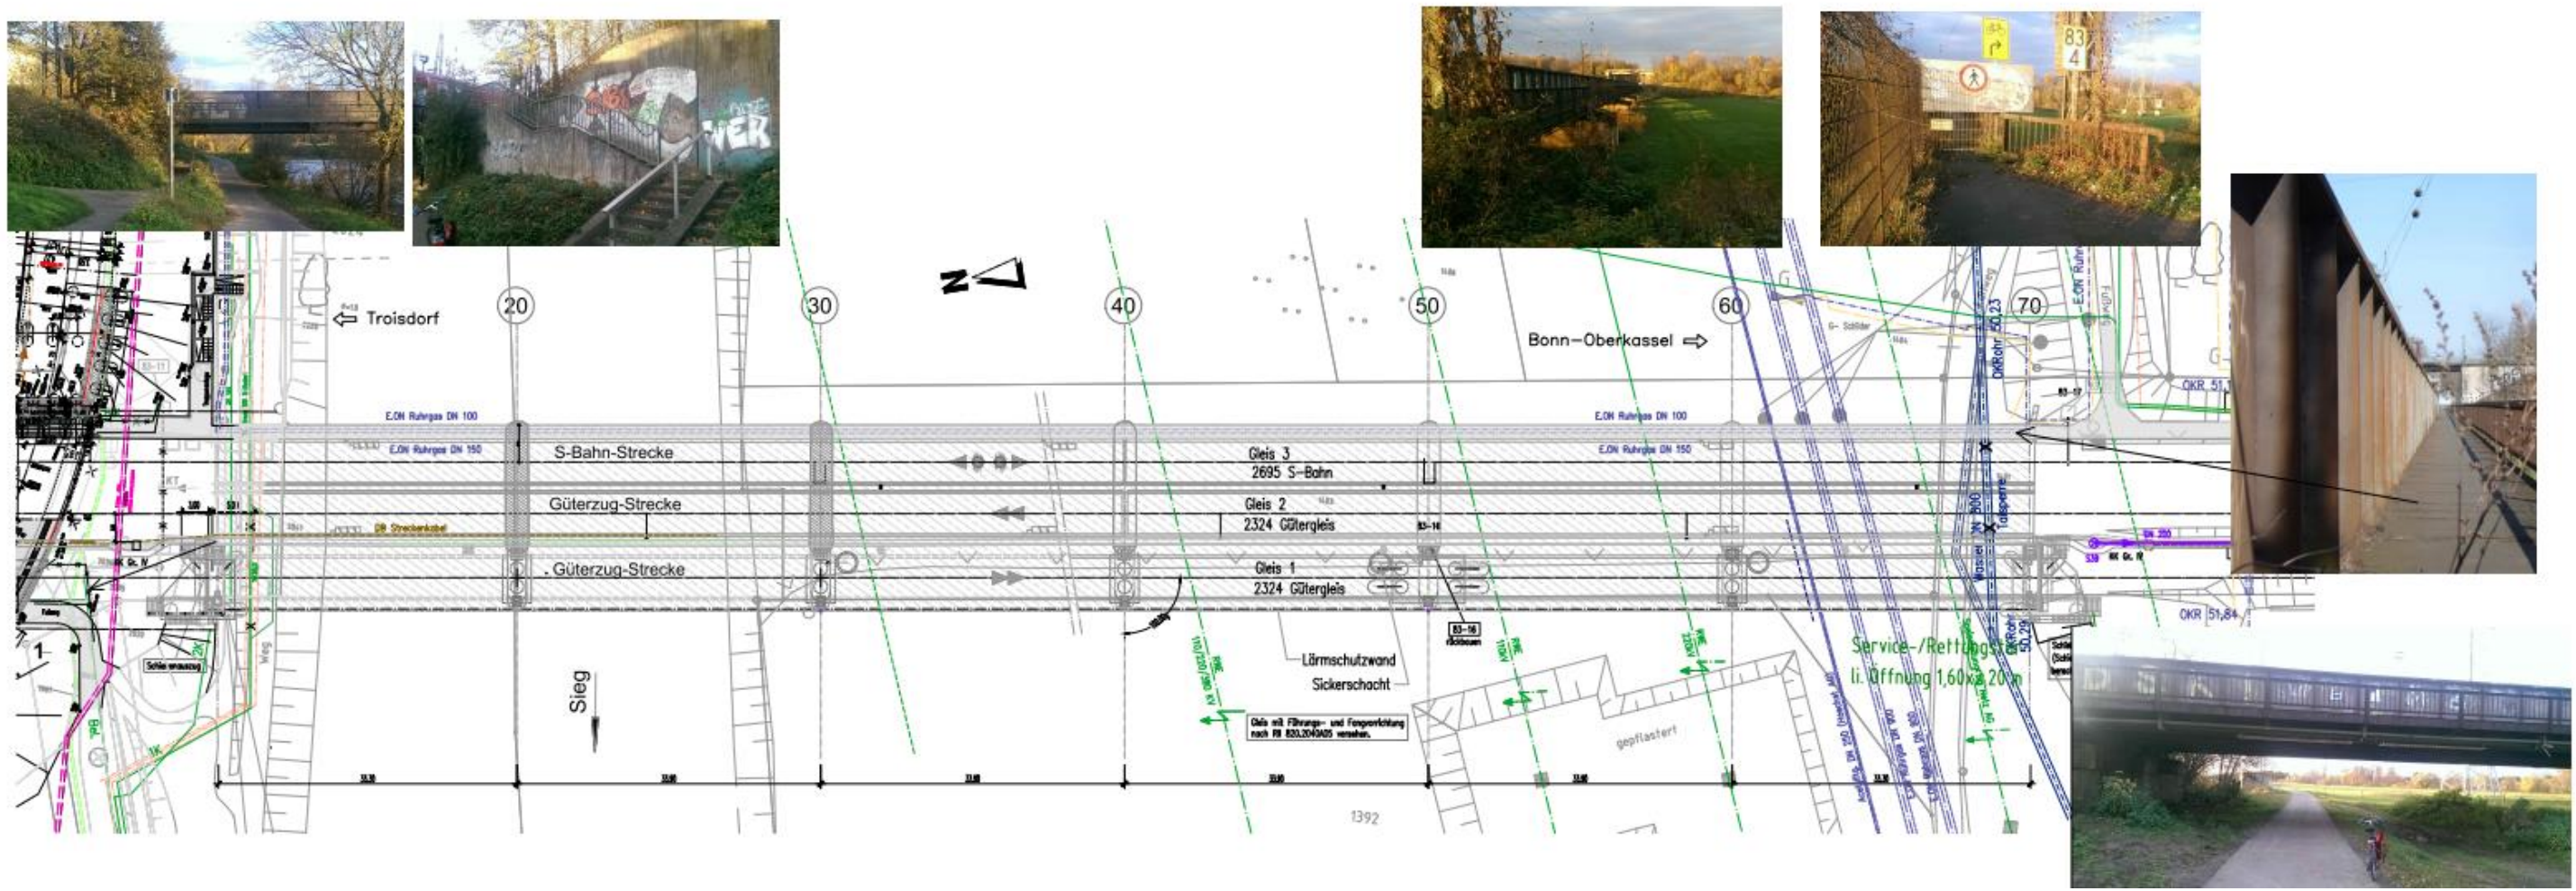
Grundriss_Variante IIc - Ostseite
